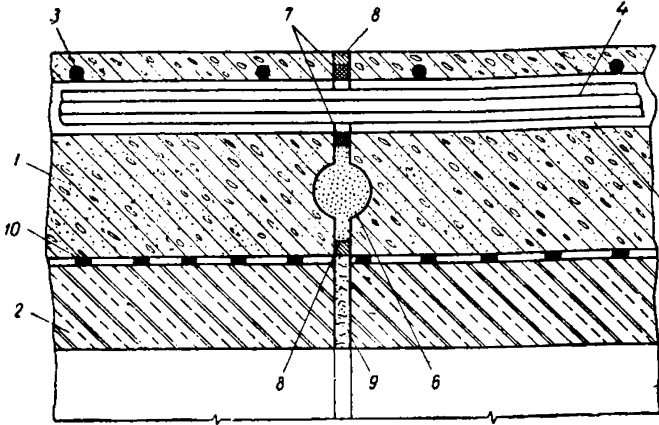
Узел соединения царг предварительно напряженных труб с пучковой арматурой
